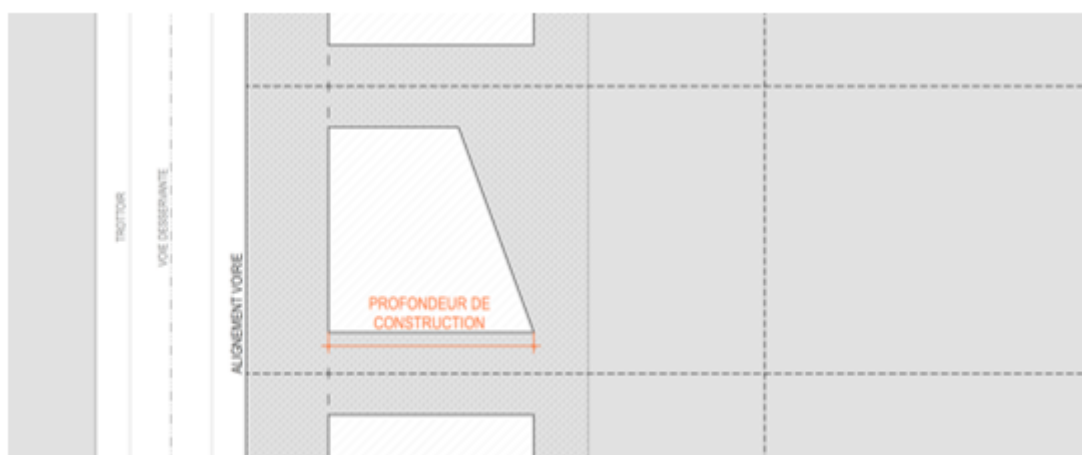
Profondeur de construction - construction comportant une façade oblique
